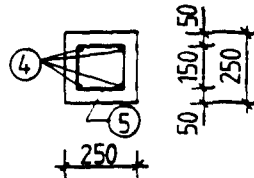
Bewehrungsführung, Prüfkörper P 0,5 - o/mB
